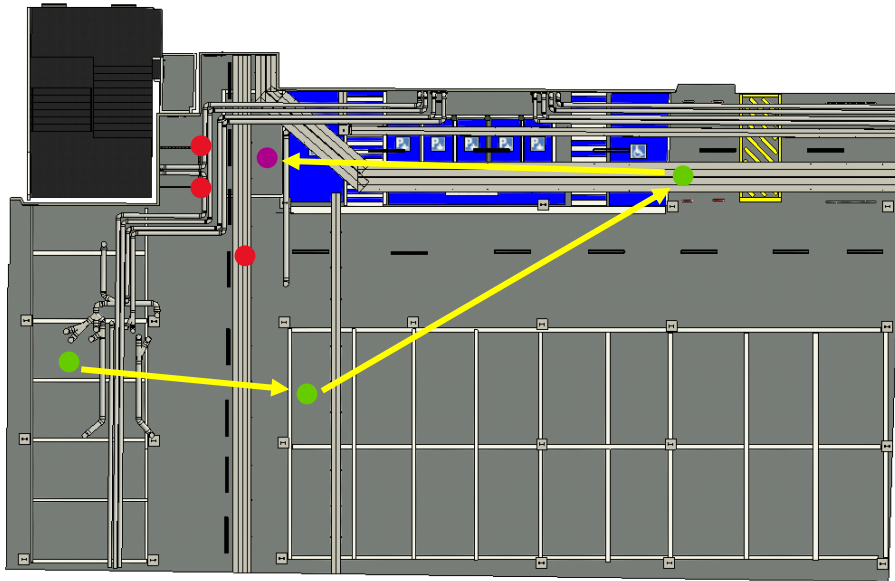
Plano Estación Número 4 Fuente: Elaboración Propia
